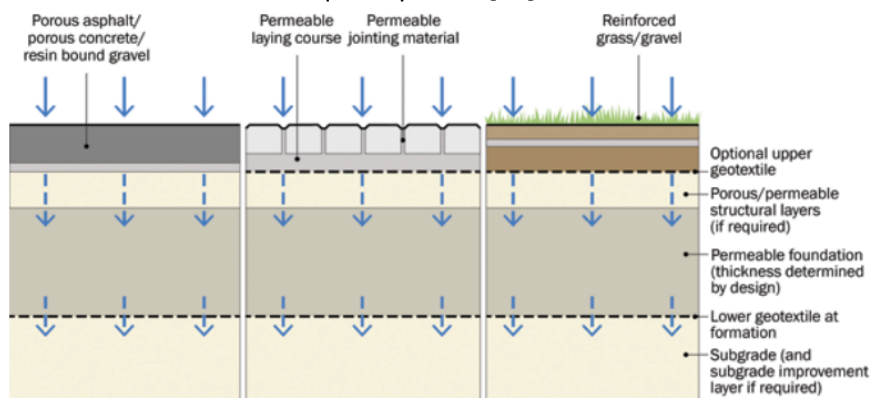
Sezioni tipo di pavimentazioni permeabili ad infiltrazione totale – Tipo A [12].
